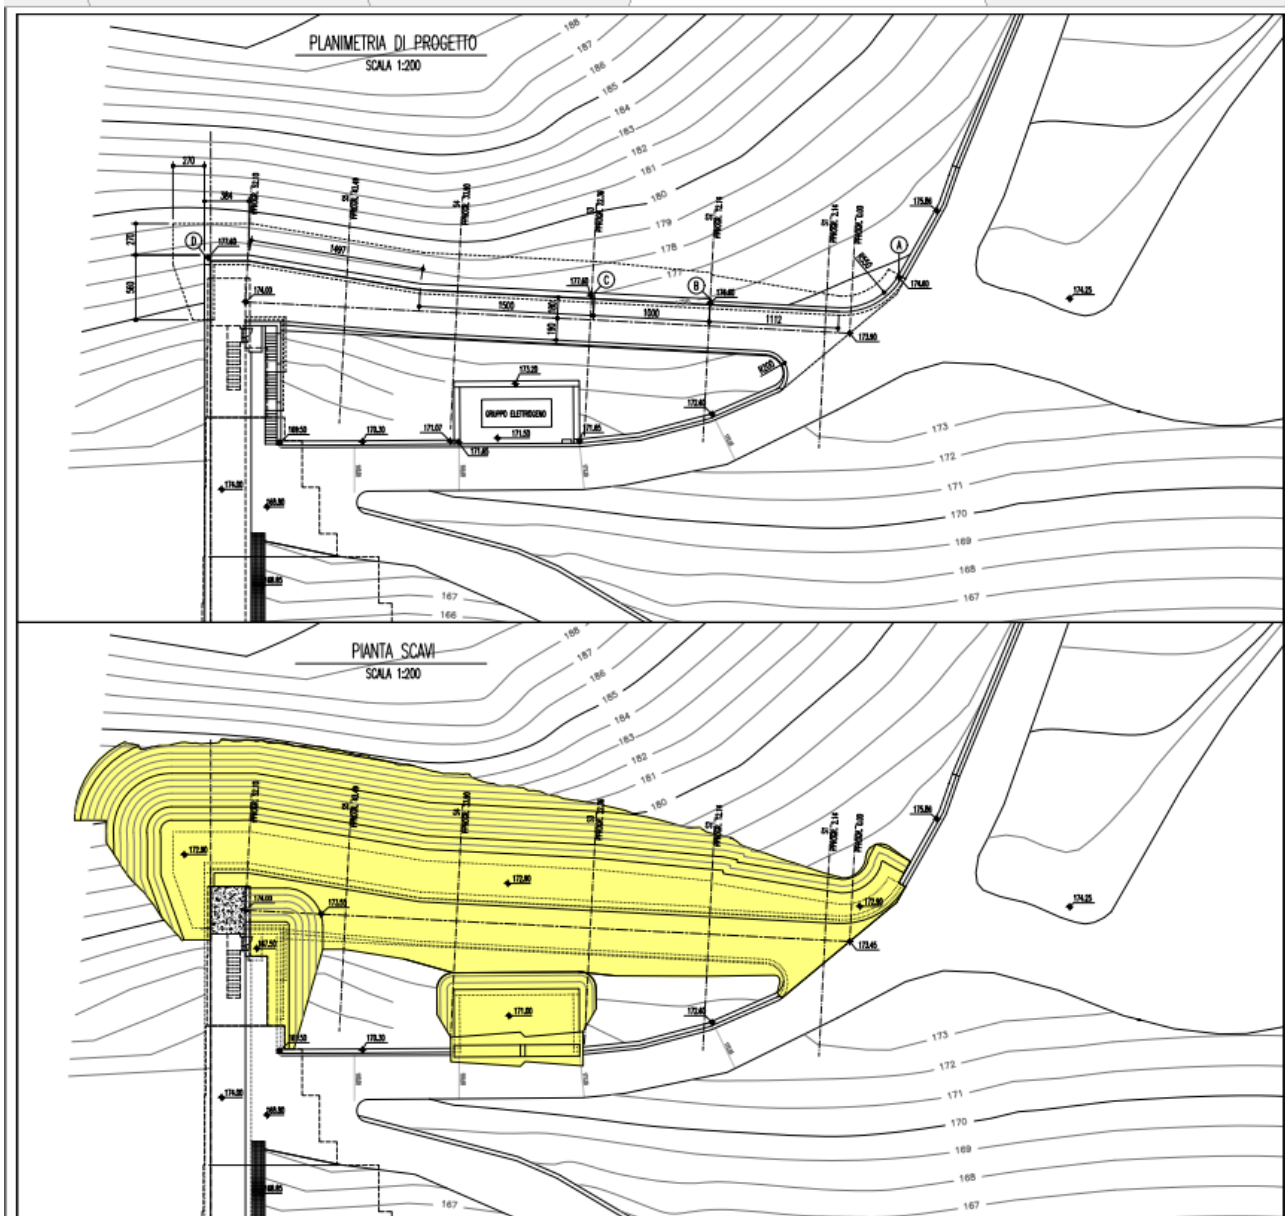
2 – PD - INQUADRAMENTO PLANIMETRICO OO.CC. IN SPONDA SX
